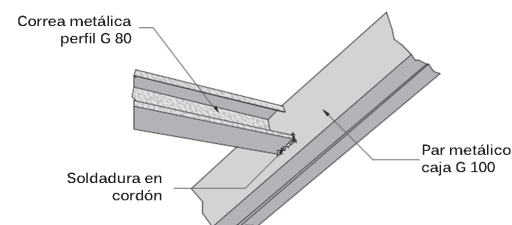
Detalle de unión entre la correa y el par metálico.
